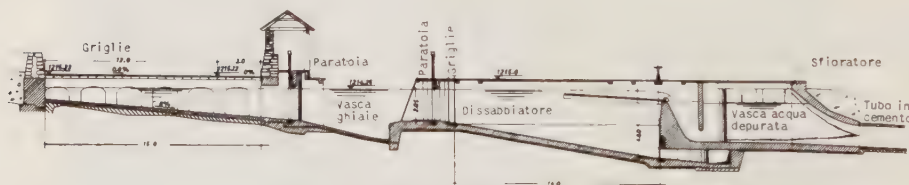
Sezione delle opere di presa sul Teuchlbach.
